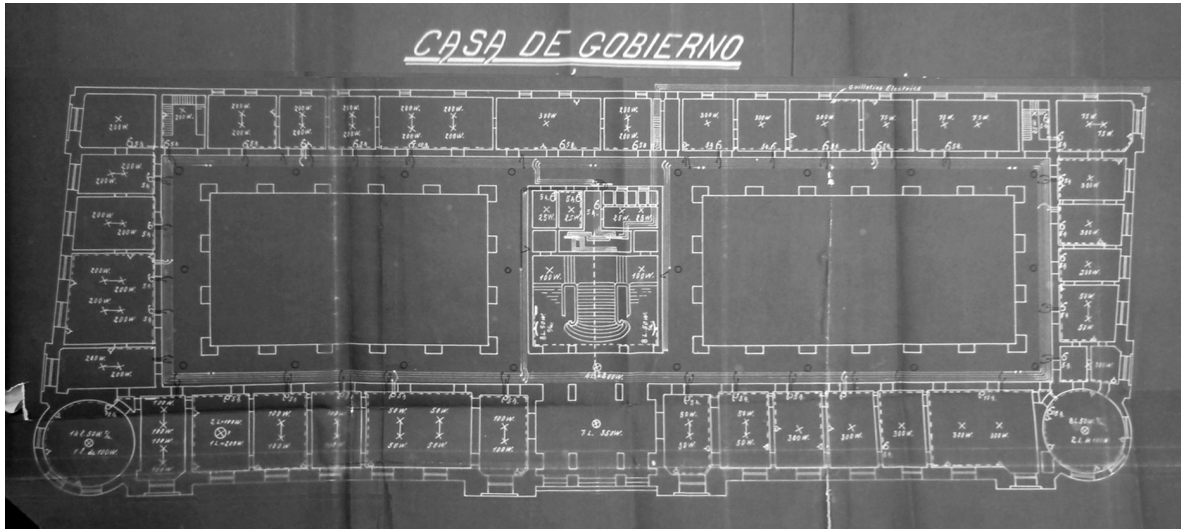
Planta baja Casa de Gobierno, proyecto definitivo (SA DIP, 1910). Fuente: Archivo MOP, Departamento La Capital, AGPSF.
